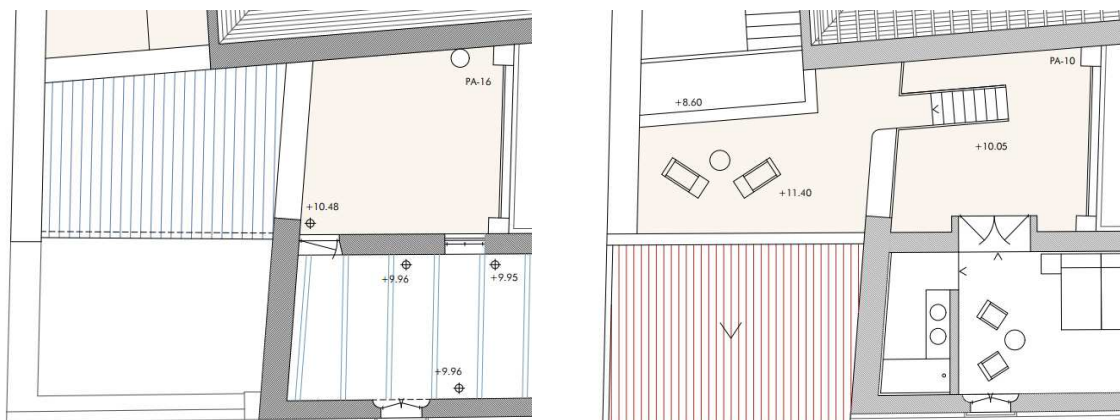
Planta de cámaras. Estado previo (izquierda) y estado reformado (derecha)
